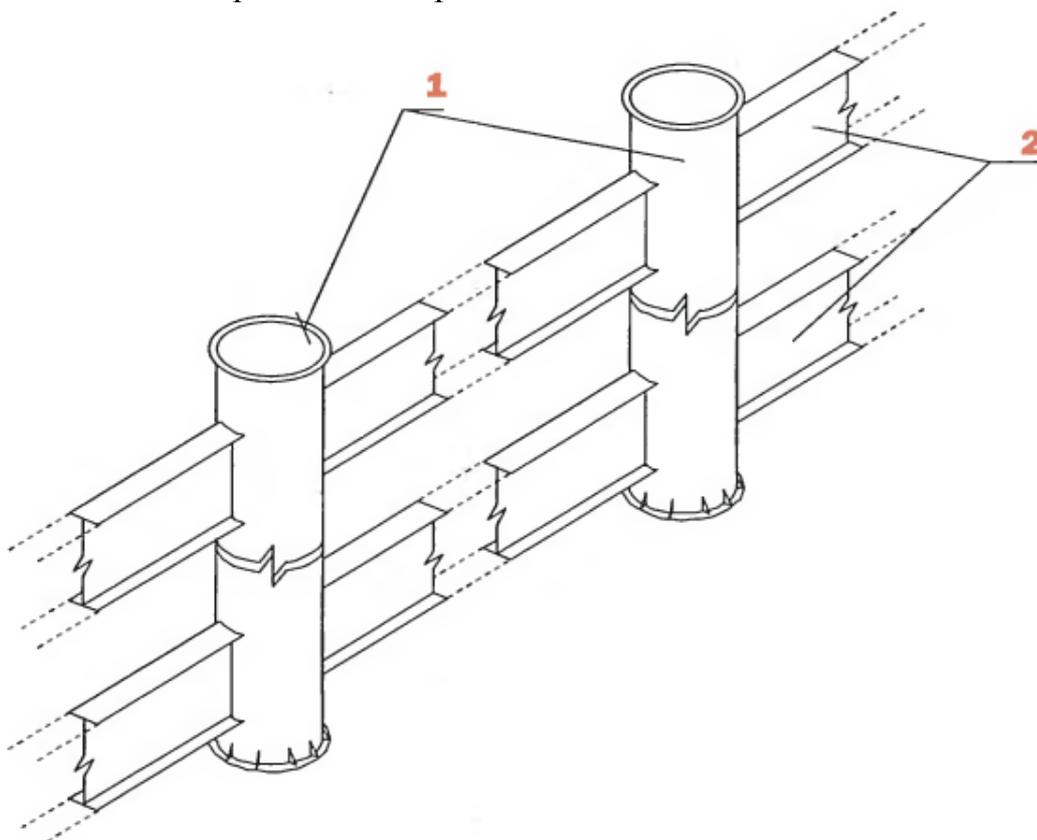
Узлы жесткого примыкания стальных неразрезных главных балок рам каркаса и перекрытий на трубобетонные колонны для высотных зданий:
